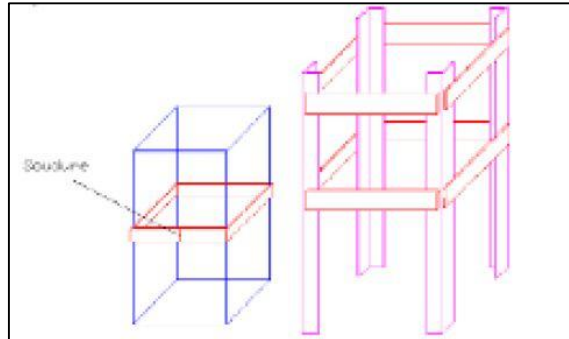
renforcement des poteaux par des lamelles métalliques
